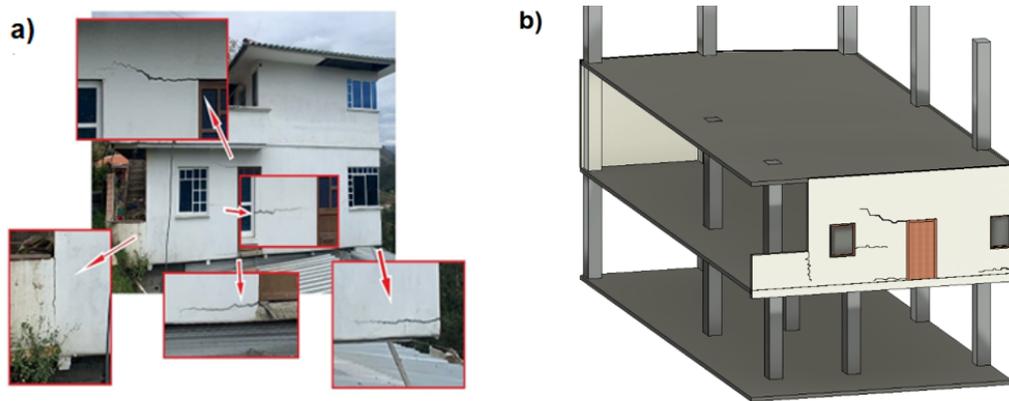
Casa 12. a) Detalle de fisuras en vivienda. b) esquema de la vivienda con la ubicación de fisuras
